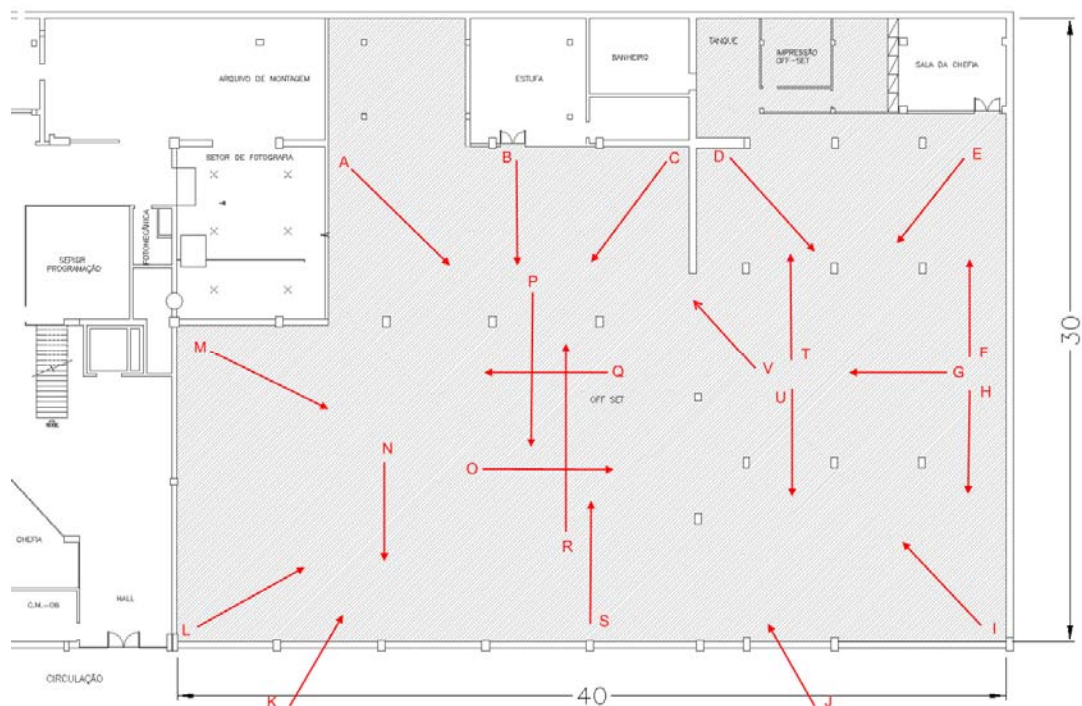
Planta mostrando área para climatização (hachurada) da sala de impressoras “offset”. Posição e direção das fotos indicados pelas setas vermelhas (posições, direções e dimensões da planta são aproximadas)
